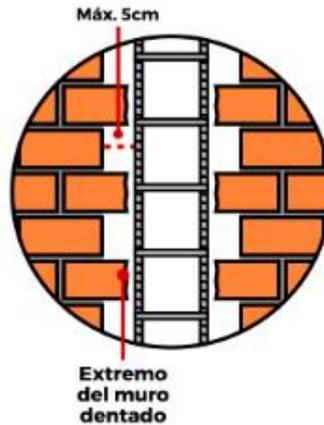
Parámetros de la NTP E.070 – Albañilería en el tipo de conexión dentado.
